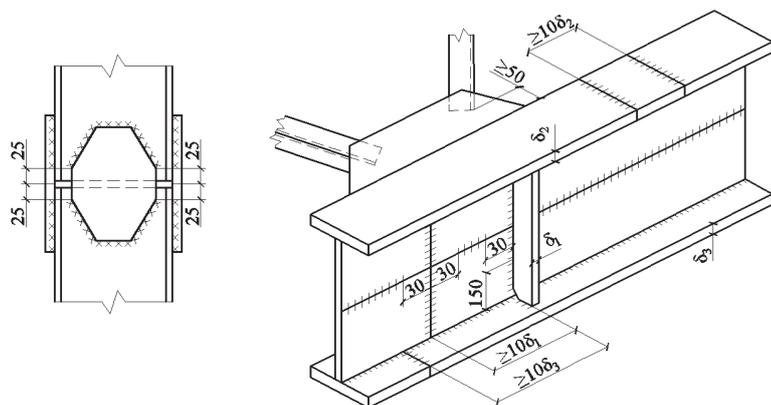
Основные конструктивные требования к обустройству сварных швов при приваривании деталей к стальным конструкциям согласно ДБН В.2.6.198 (справочно) [33]
